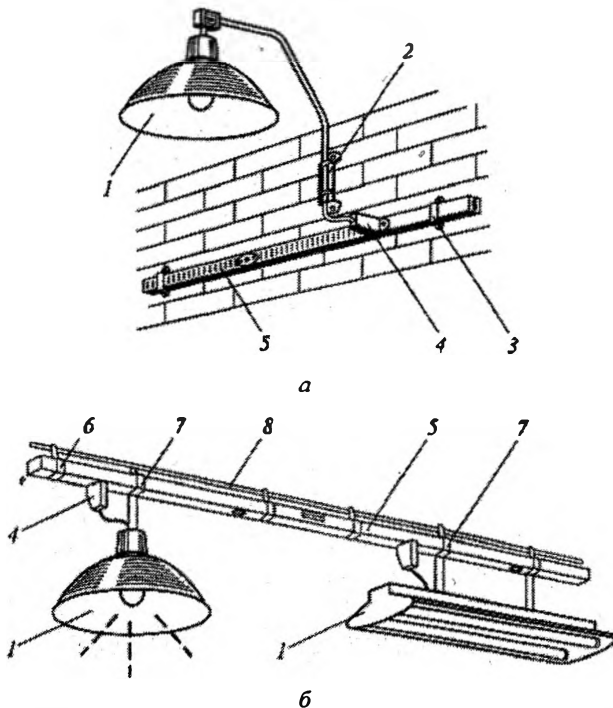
Кріплення шинопроводу ШОС-67 безпосередньо на стіні (а)
